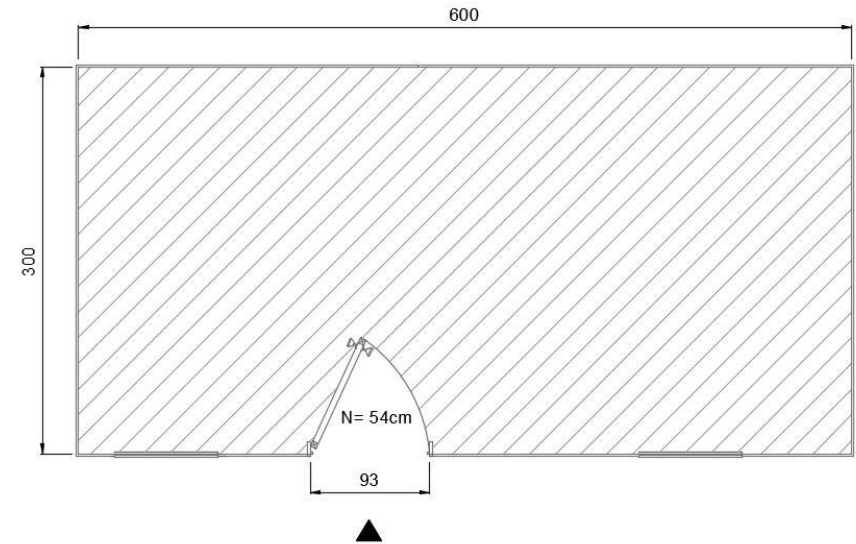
Plano acotado de la vivienda tipo de TECHO, Fuente: Manual para la construcción - TECHO
